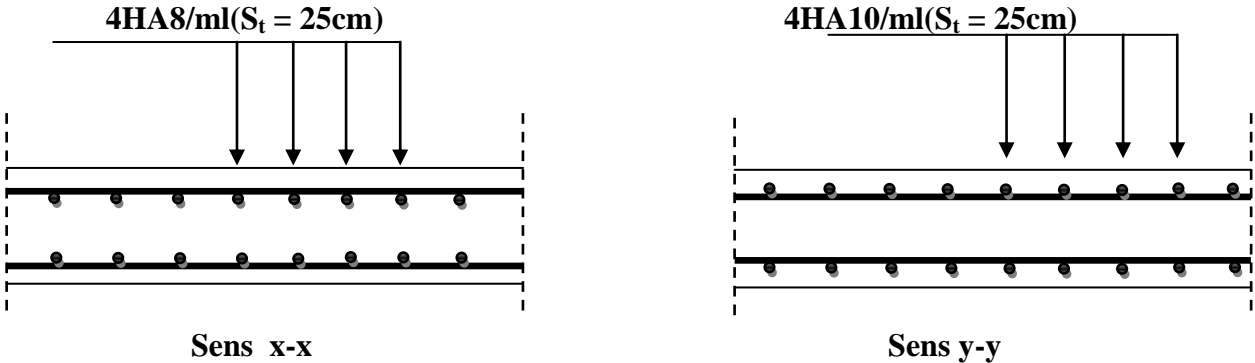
Ferrailage de la dalle pleine de la salle machine.
